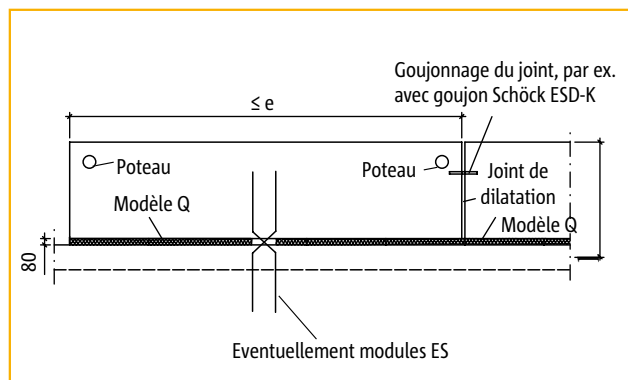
disposition des joints de dilatation sur des dalles de balcon raccordées en ligne droite
